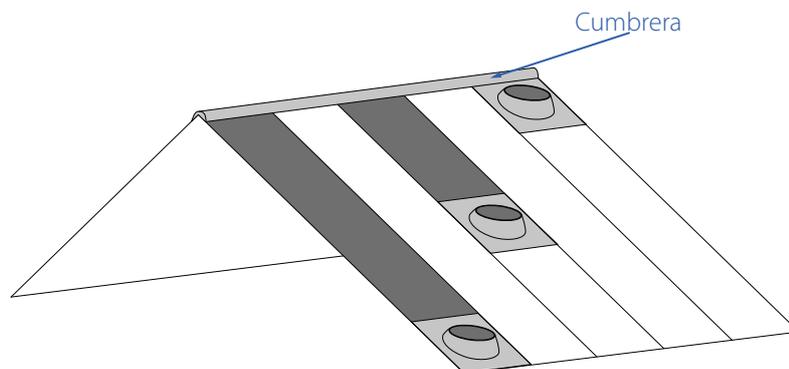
Colocación de la chapa para el montaje de las chimeneas
